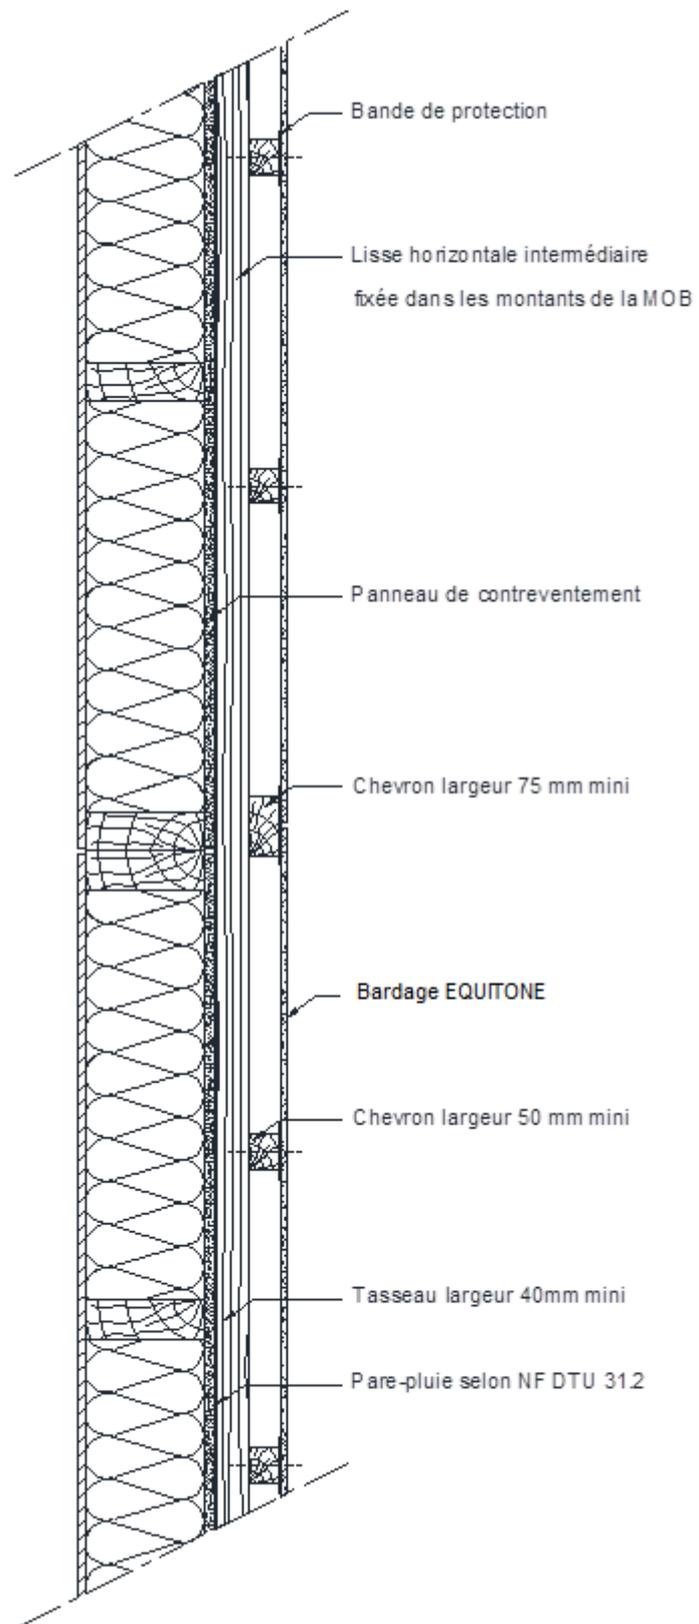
Ossature croisée - Pose sur COB (Coupe horizontale)
